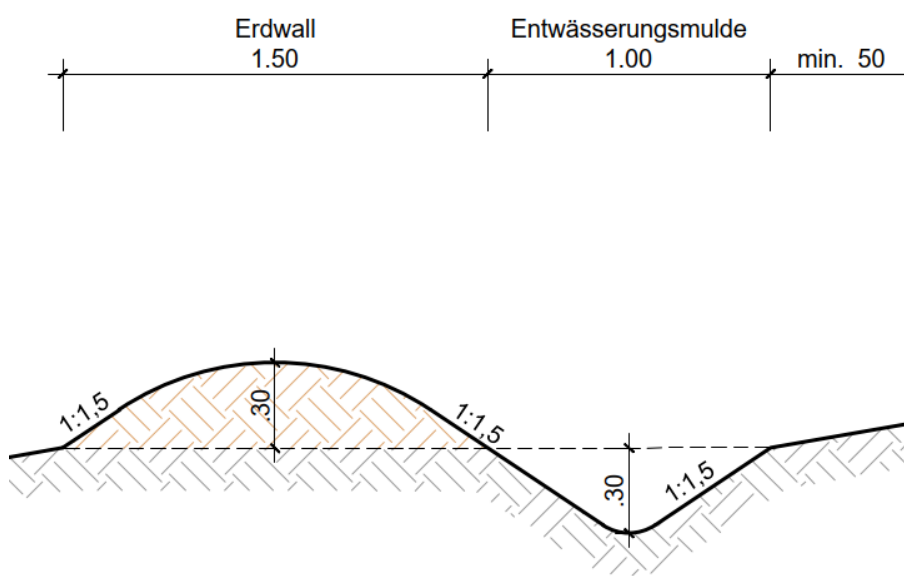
Mulde und Wall zum Schutz vor Außengebietswasser
